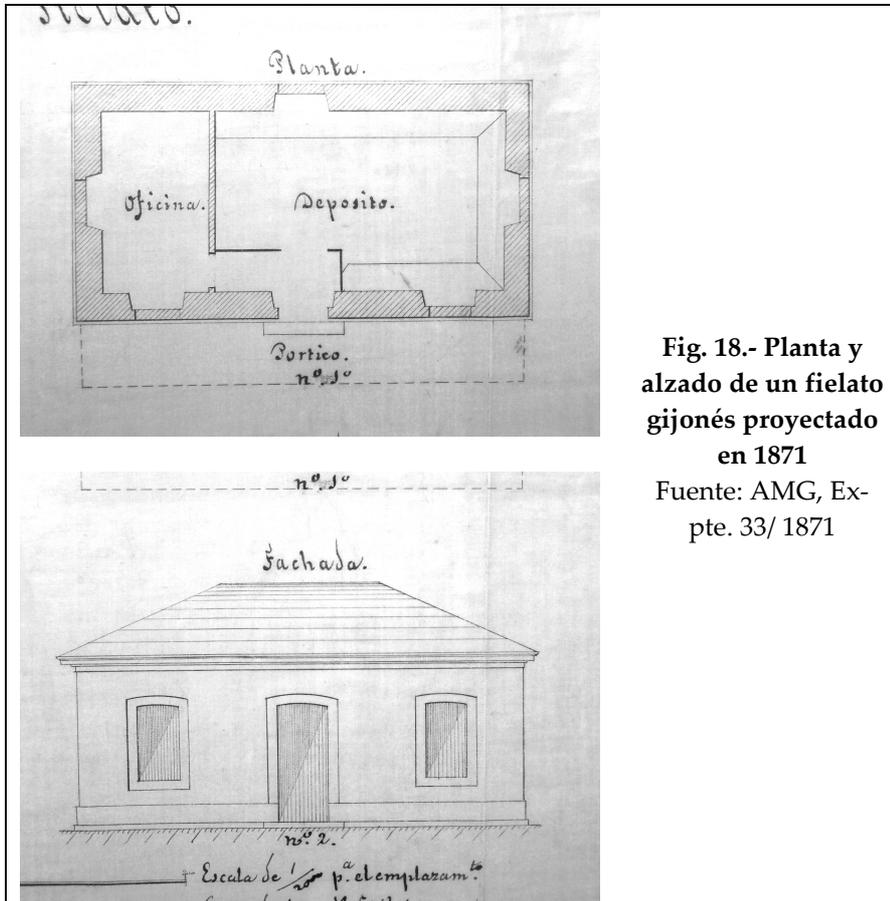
Planta y alzado de un fielato gijonés proyectado en 1871
